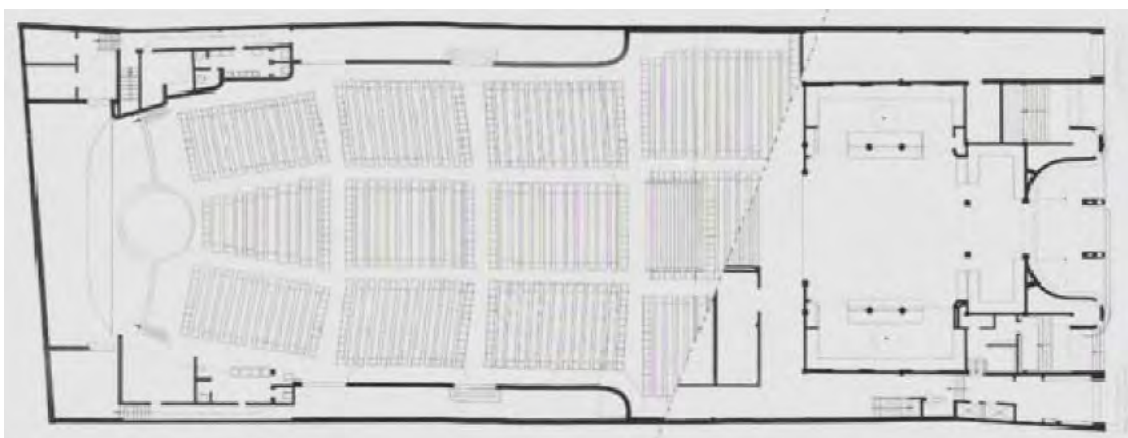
Planta Baixa UFA Palace Fonte: TAMANINI, 2011
